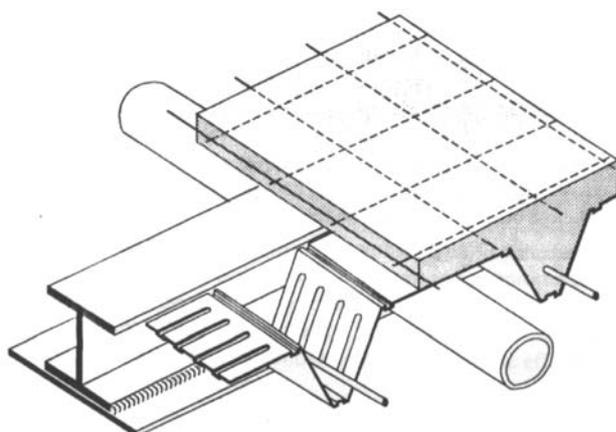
Sistema com forma metálica incorporada (“*Fast track slim floor*”)
